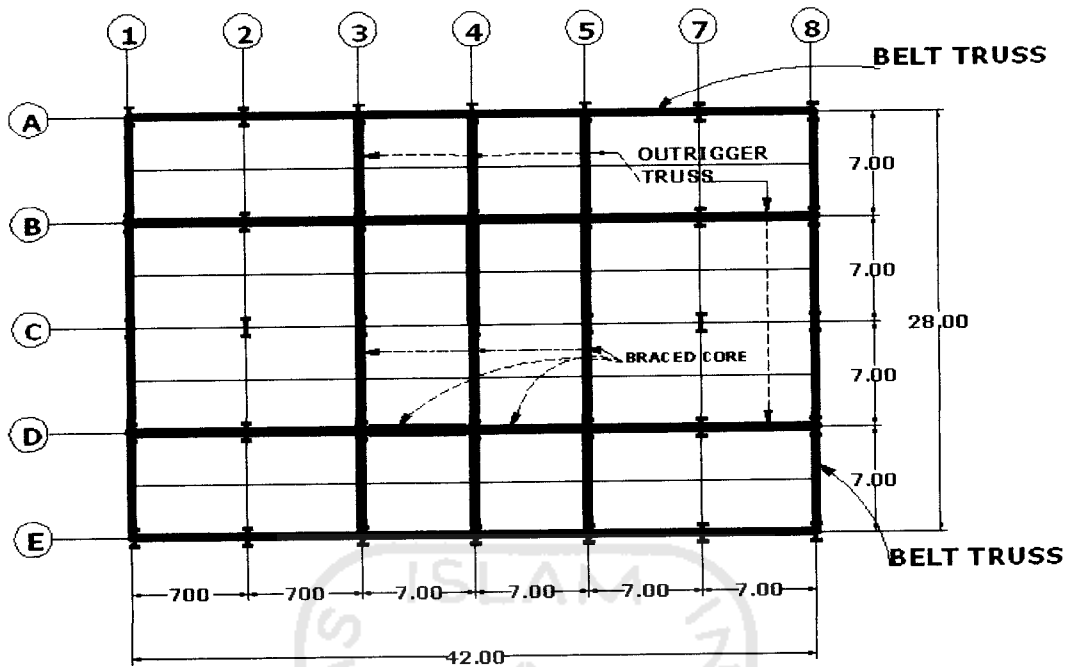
Penamaan Balok dan Kolom struktur 20 lantai.
